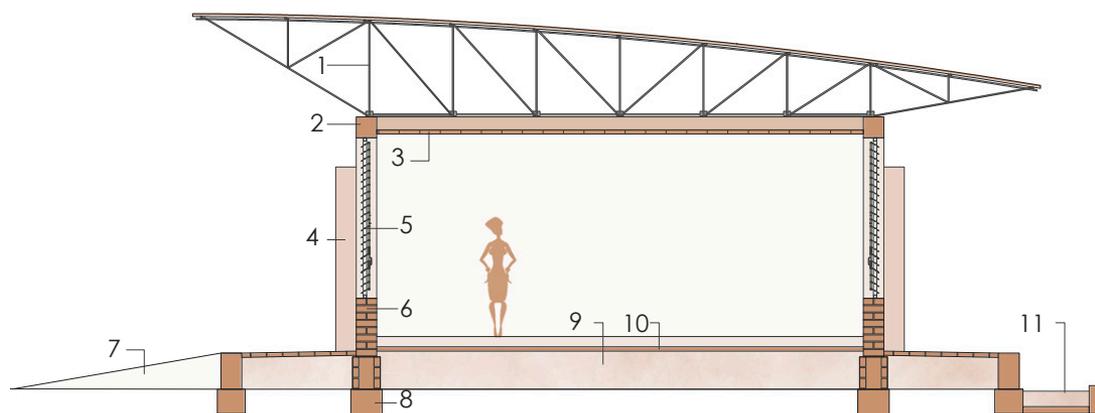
Sección constructiva. 1. Cubierta de láminas de zinc sobre vigas de acero soldadas. 2. Viga superior de hormigón. 3. Techo de ladrillos de adobe. 4. Contrafuertes. 5. Ventana con persiana de lamas de acero. 6. Muro de carga de adobe. 7. Rampa de hormigón. 8. Zapata continua de hormigón. 9. Relleno de arcilla y piedra. 10. Suelo de arcilla comprimida 11. Conductor de agua de lluvia.
